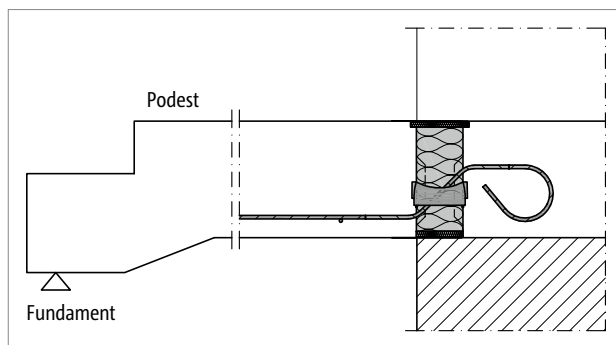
Schöck Isokorb® T Typ QL: Anschluss Treppenlauf bei einschaligem, wärmedämmendem Mauerwerk
